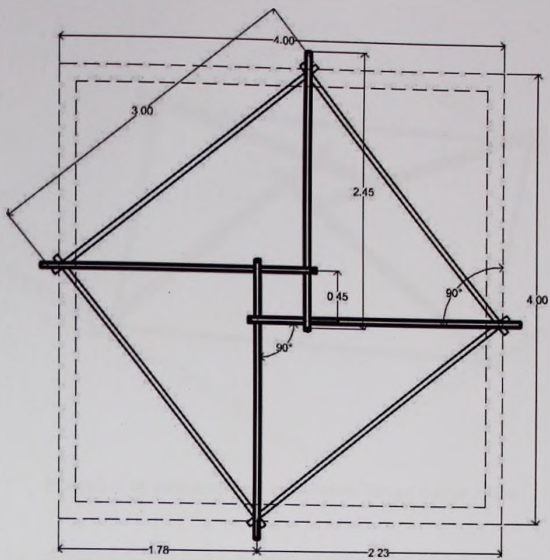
Estructura en Planta Dibujo: Carlos Uribe
